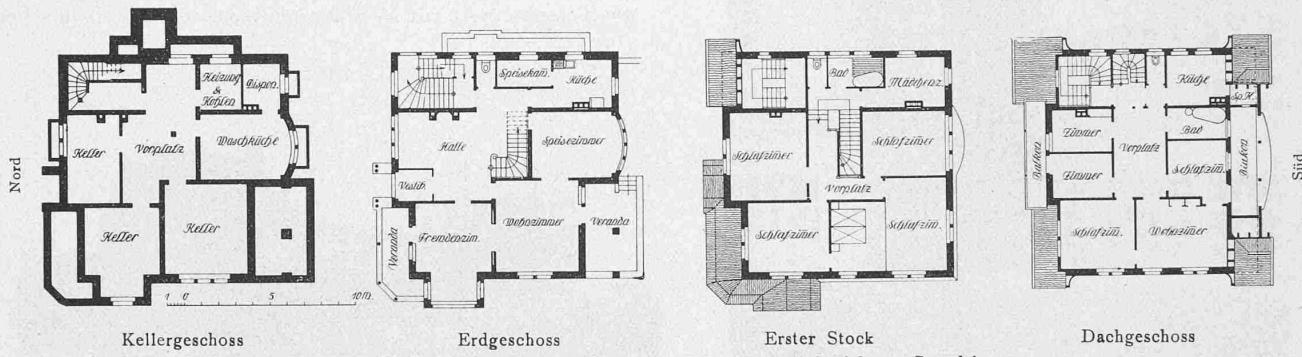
bis 4. Zweifamilienhaus am Kappeliweg in Zollikon bei Zürich. — Grundrisse 1:400.
